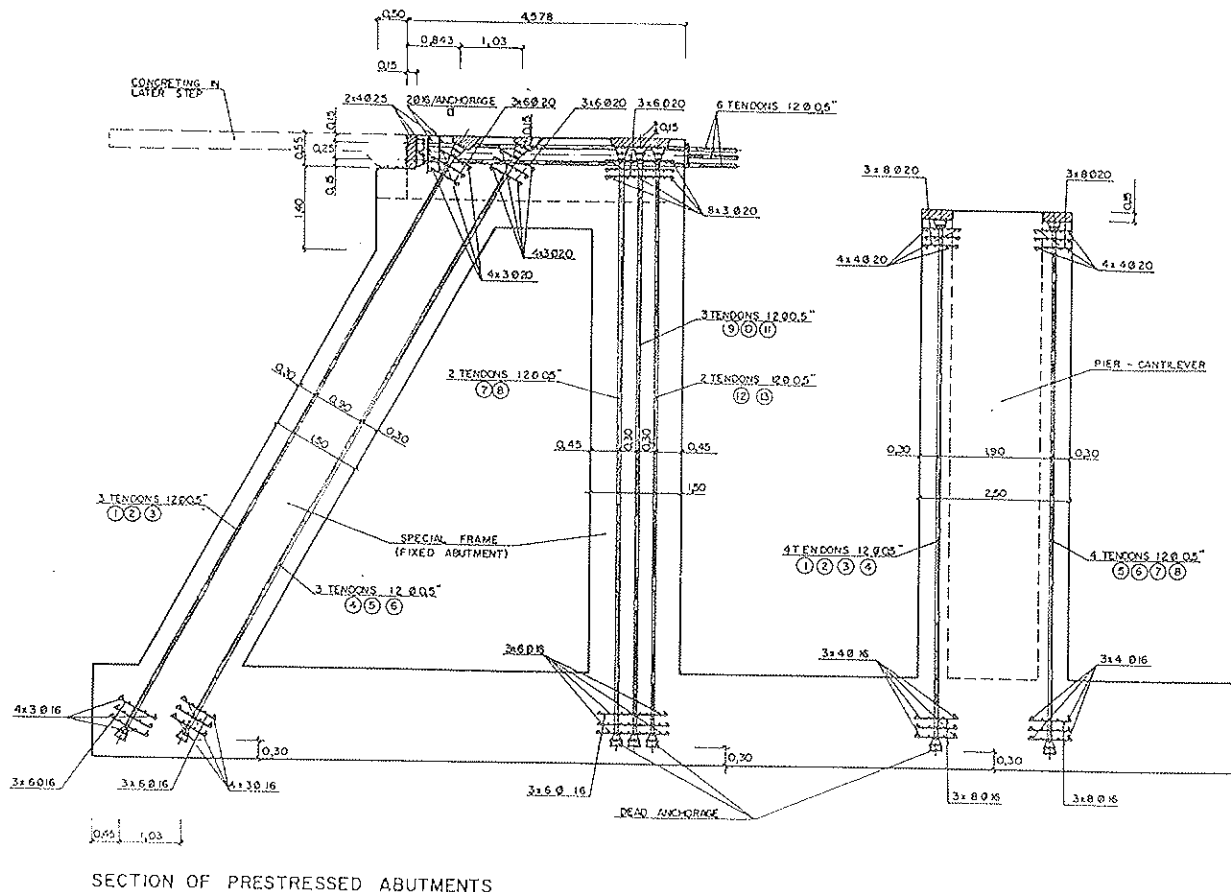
Estribo fijo y pila embebida en el muro. Pretensado.
